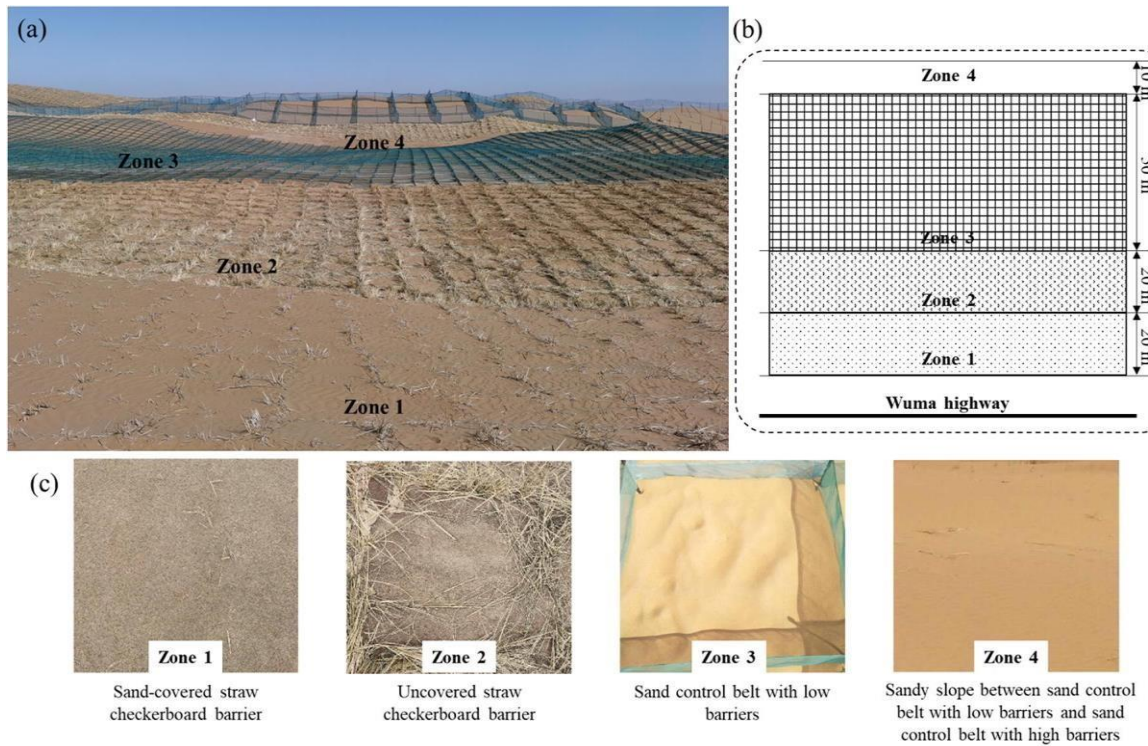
Site d'essai sur le terrain : (a) zones d'essai 1 à zones d'essai 4 sur le site d'essai sur le terrain ; (b) croquis en plan des zones d'essai 1 aux zones d'essai 4 : (c) les caractéristiques géomorphologiques spécifiques des zones d'essai (Sun et al., 2021).
